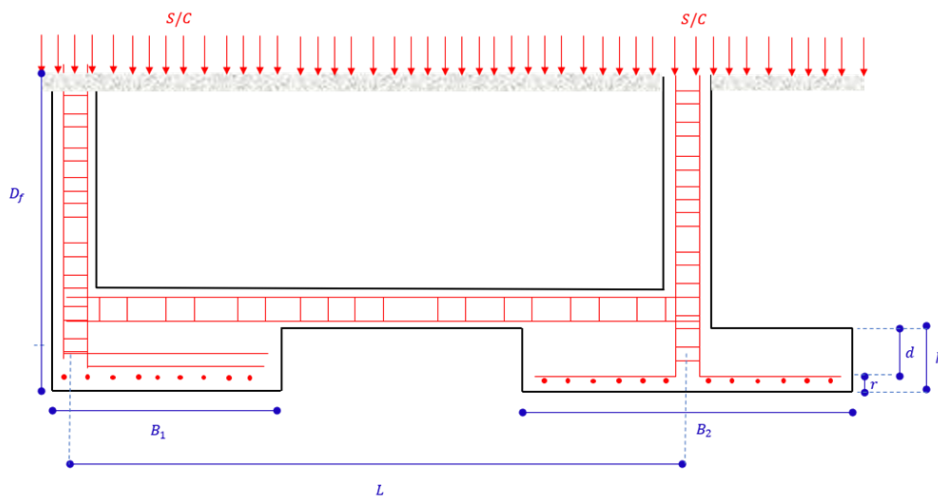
Variables para Diseño Estructural Zapata con Viga de Conexión.
